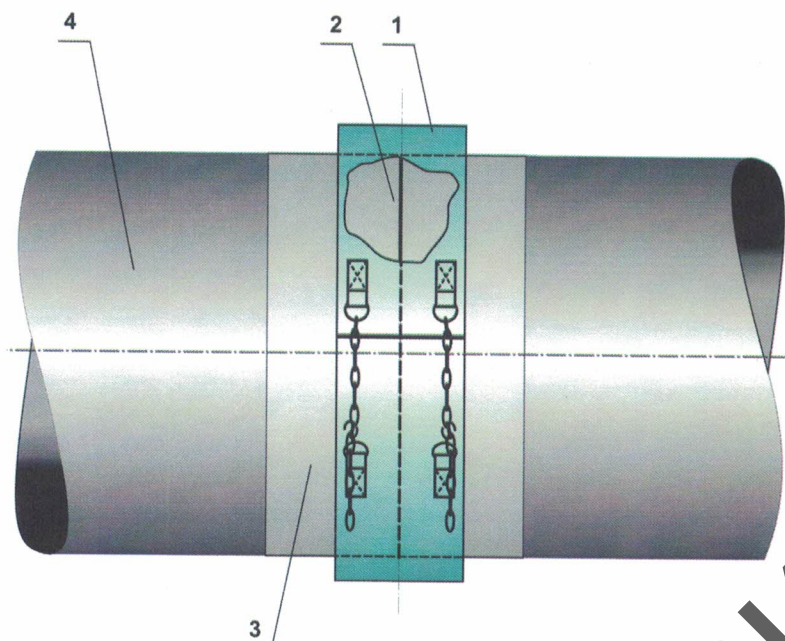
Схема установки ТПУ на сварной стык
